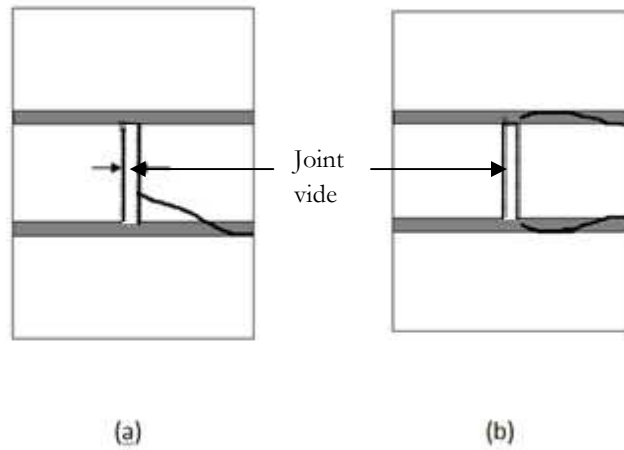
Schéma des fissurations (LAFUENTE, 1990)
